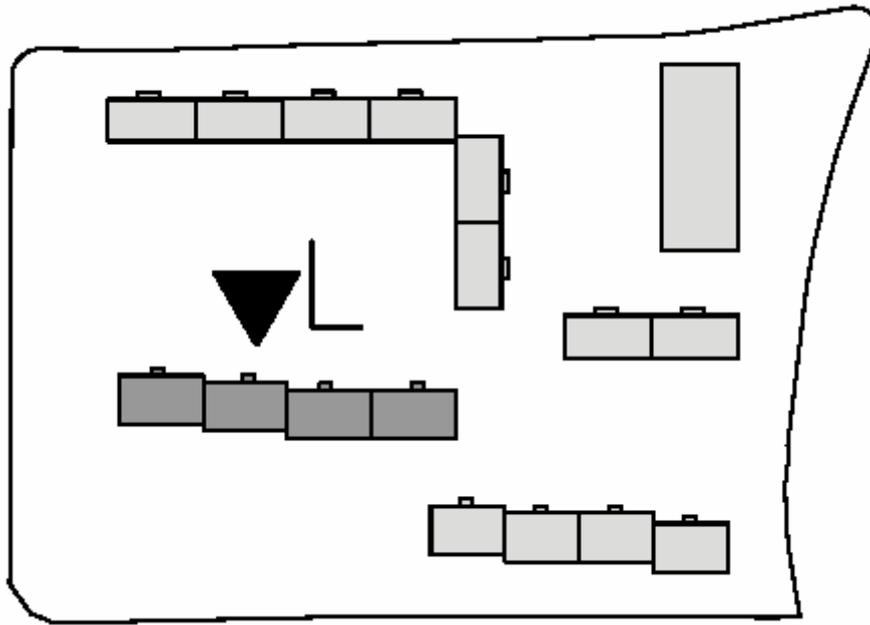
Lageplan Spallerhof V: hellgrau, Sanierungsobjekt: dunkelgrau, L: Ansicht Nord
